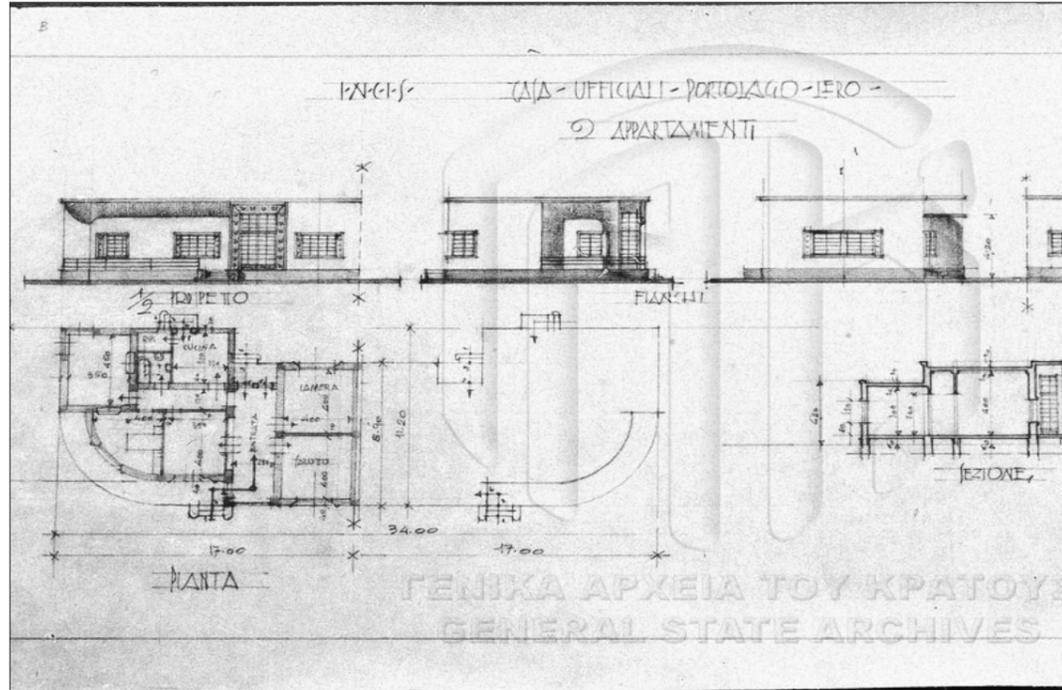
casa ufficiali B, piante prospetti e sezione, sc. 1:100
